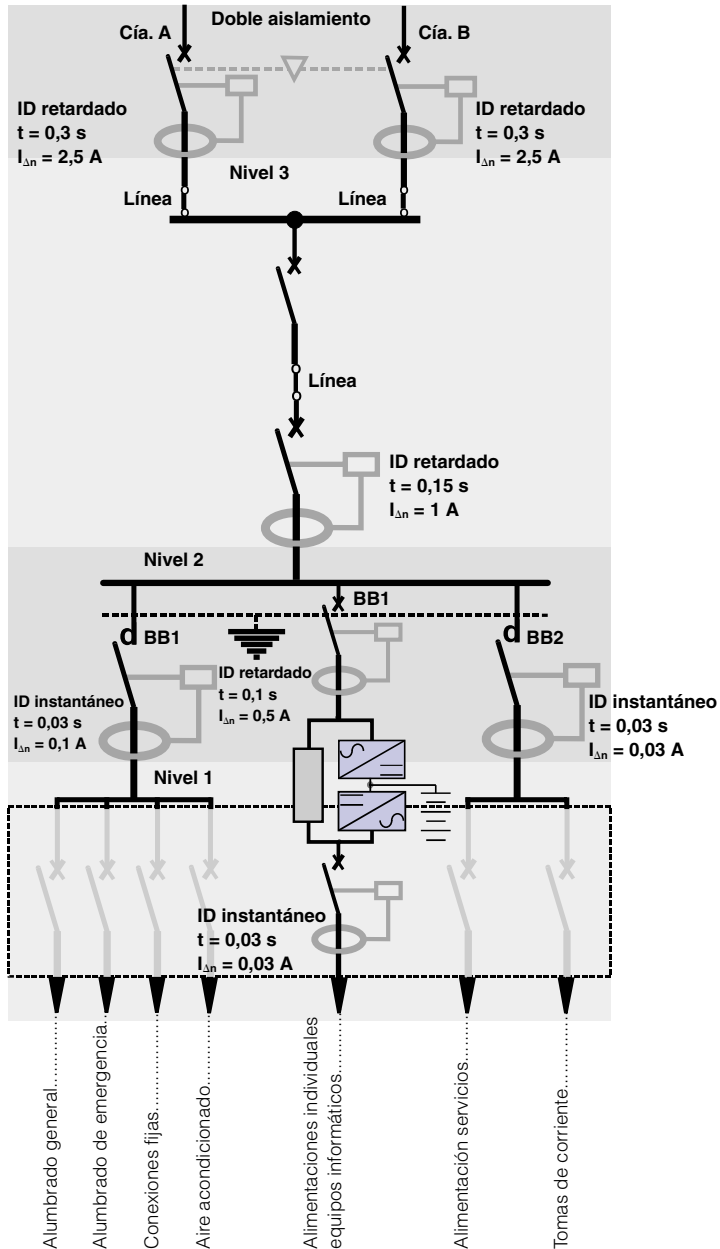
esquema protecciones contra los choques eléctricos, abonado planta 7.ª
